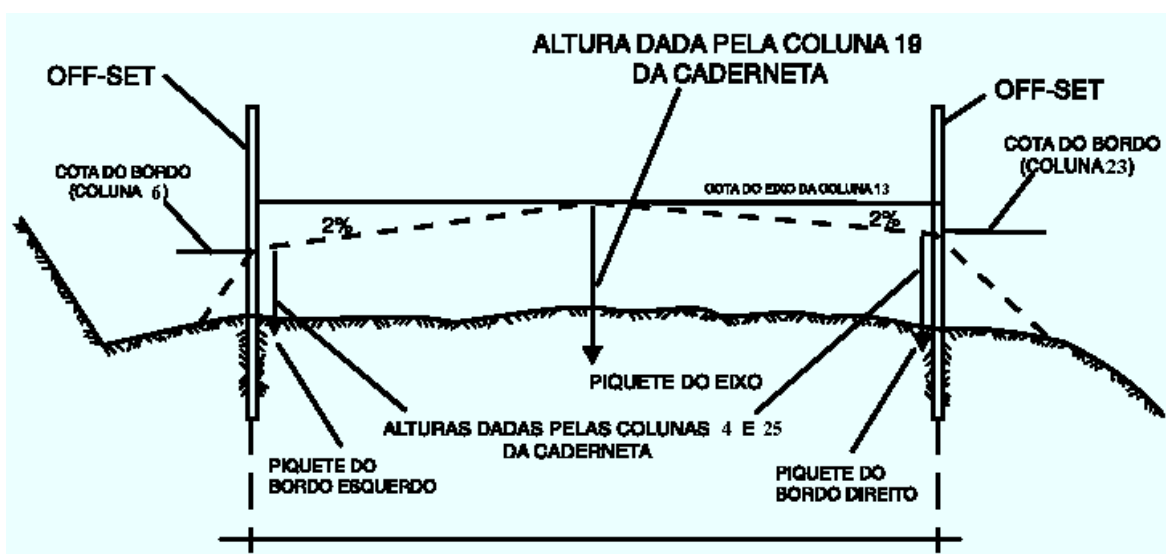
Marcação de trecho em tangente (Fonte: Pontes Filho, 1998).
